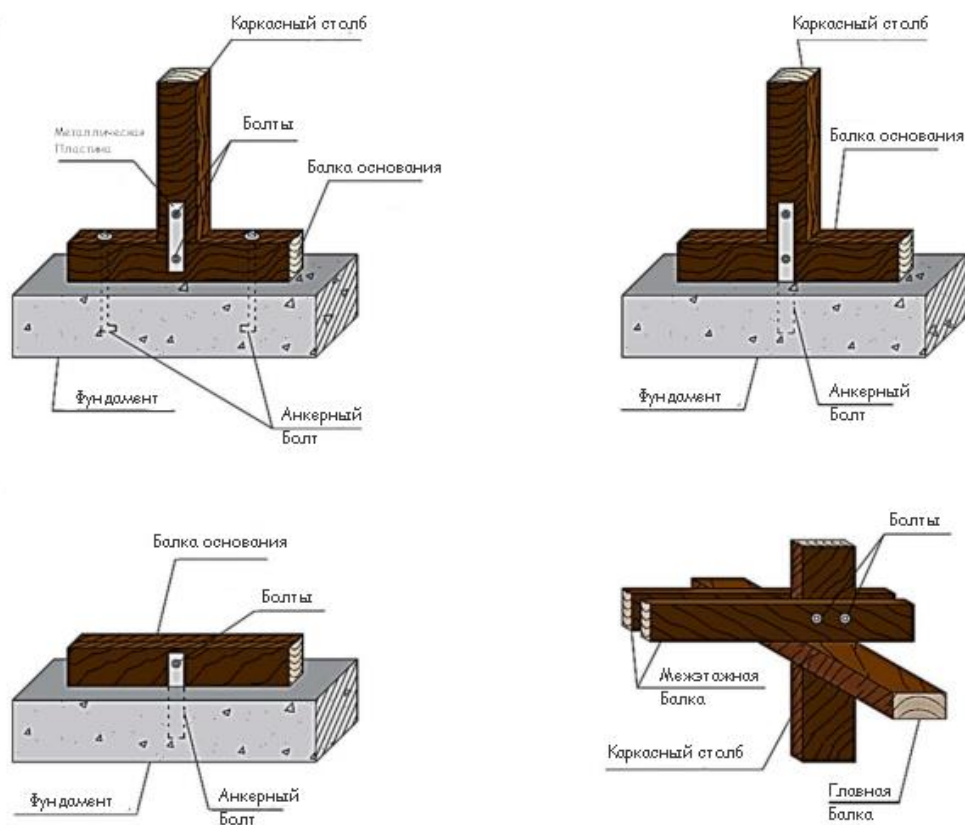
Схемы соединения деревянных балок на анкерные болты [6]
